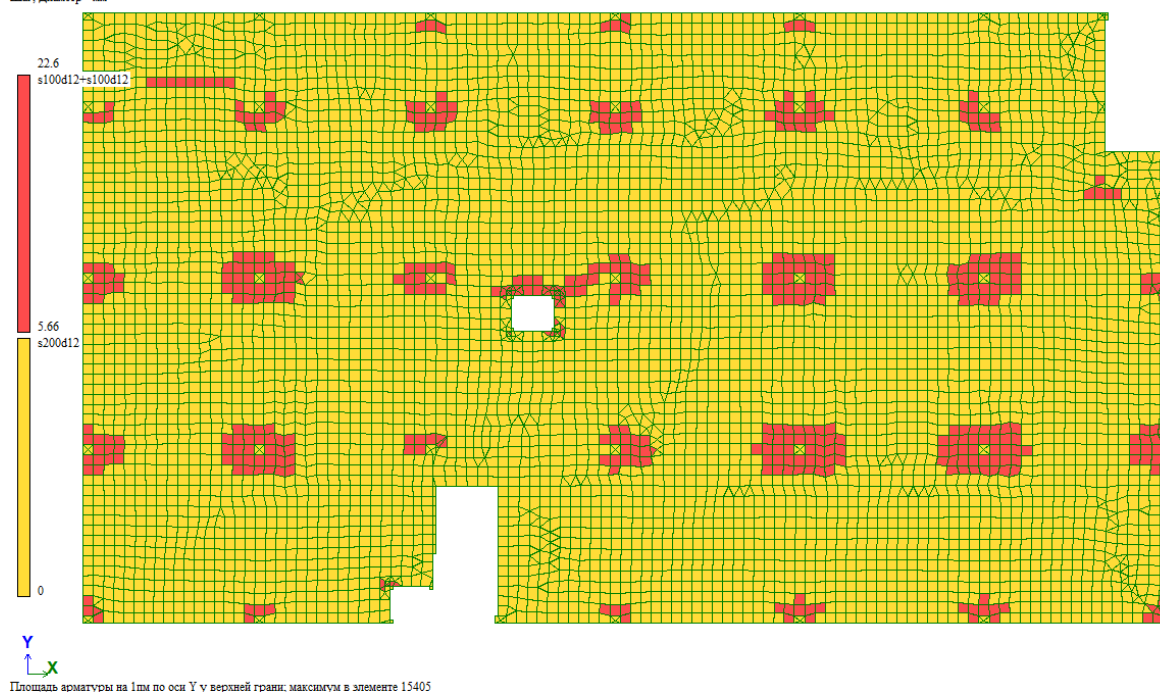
Площадь армирования на 1 м.п. по оси Y у верхней грани
